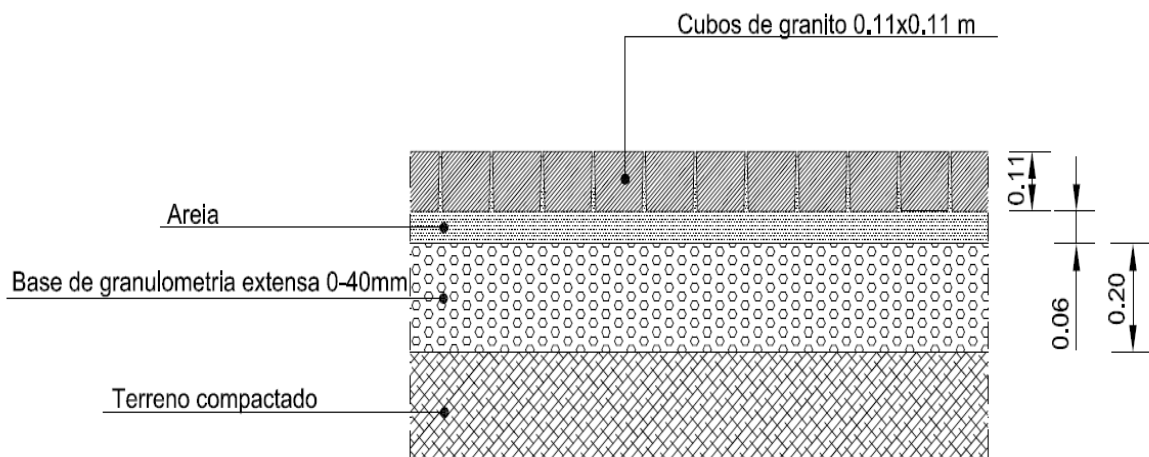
Estrutura de um pavimento em cubos de granito (MVNG, 2013)
